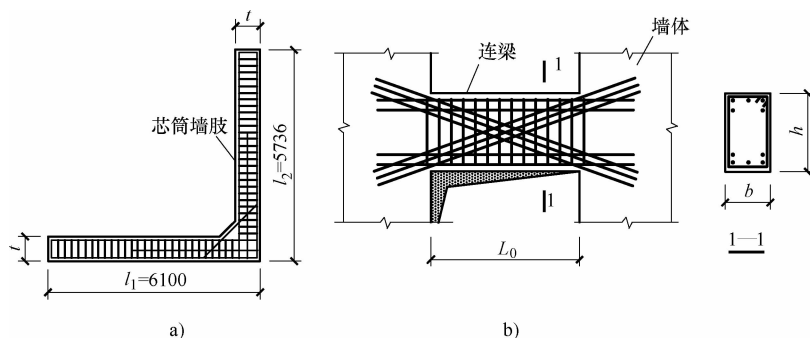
钢筋混凝土芯筒的构件截面尺寸
